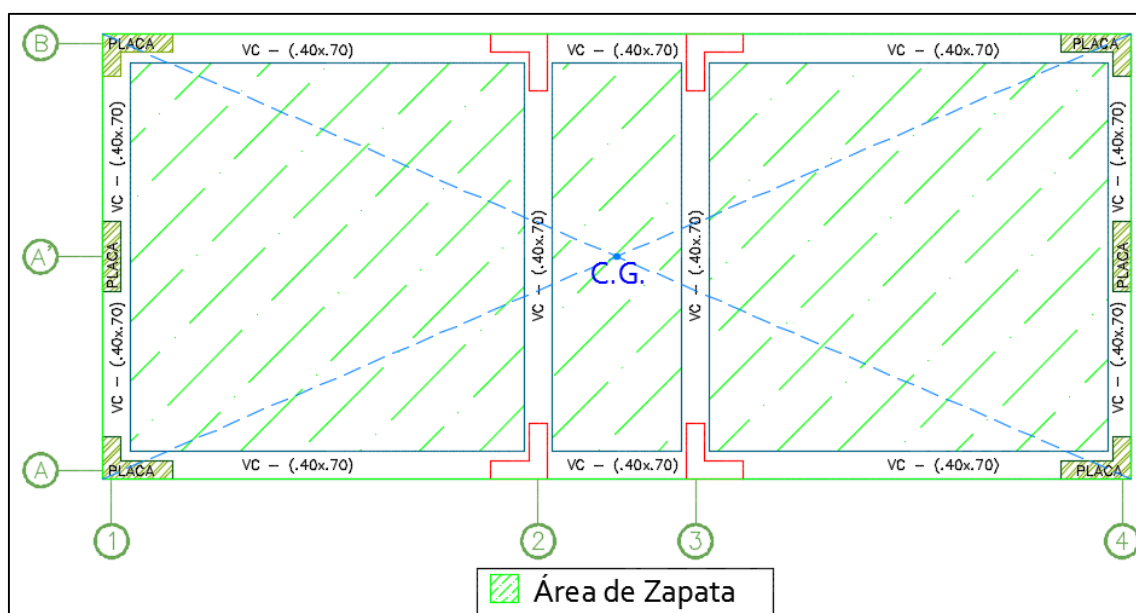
Área de contacto losa de cimentación - Sistema dual tipo II
